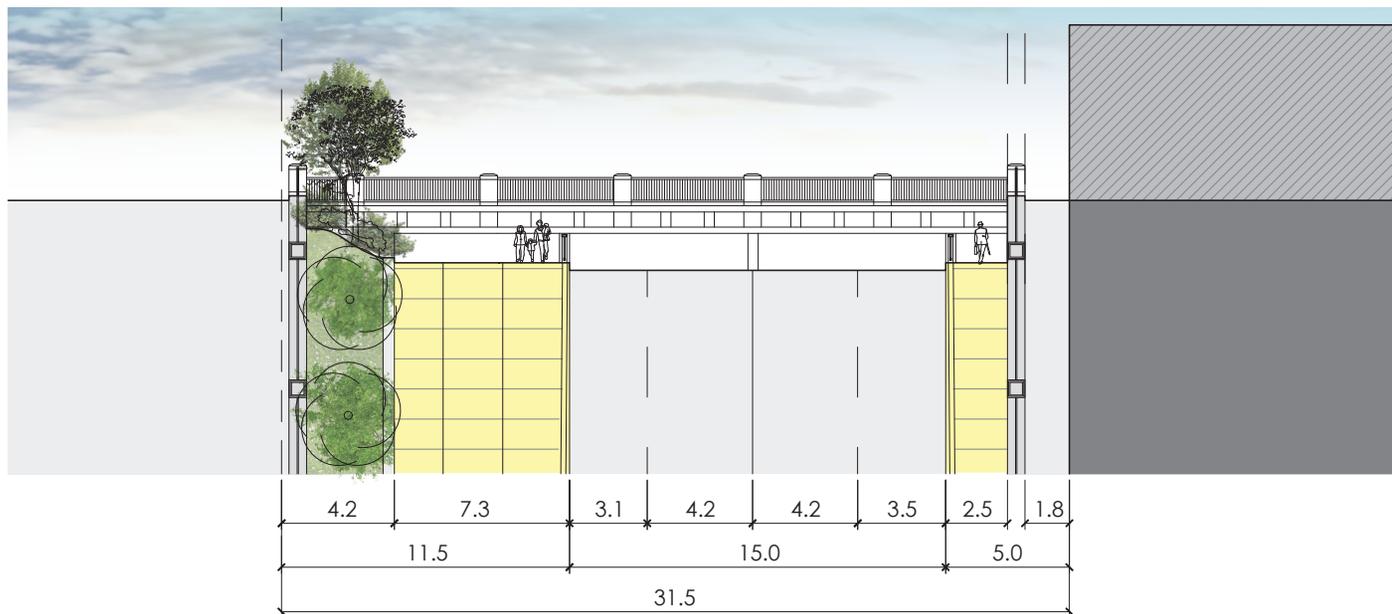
Coupe C1-C1', proposition - avenue du Parc, au sud des voies ferrées entre Van Horne et rue Beaubien O, échelle 1:300
